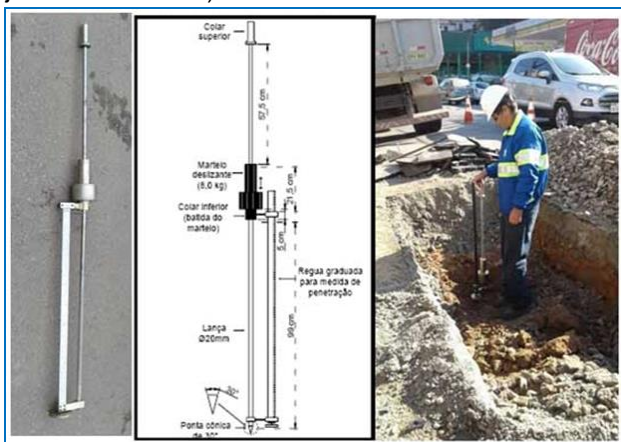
Detalhe do equipamento DCP e sua utilização em campo
